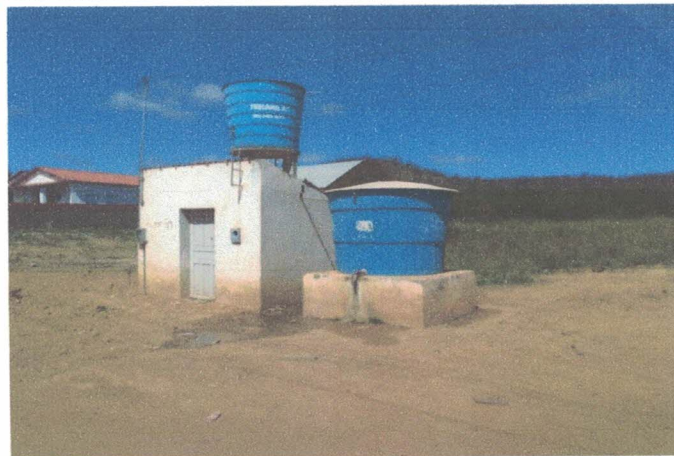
RUA PROJETADA - TRECHO 2
